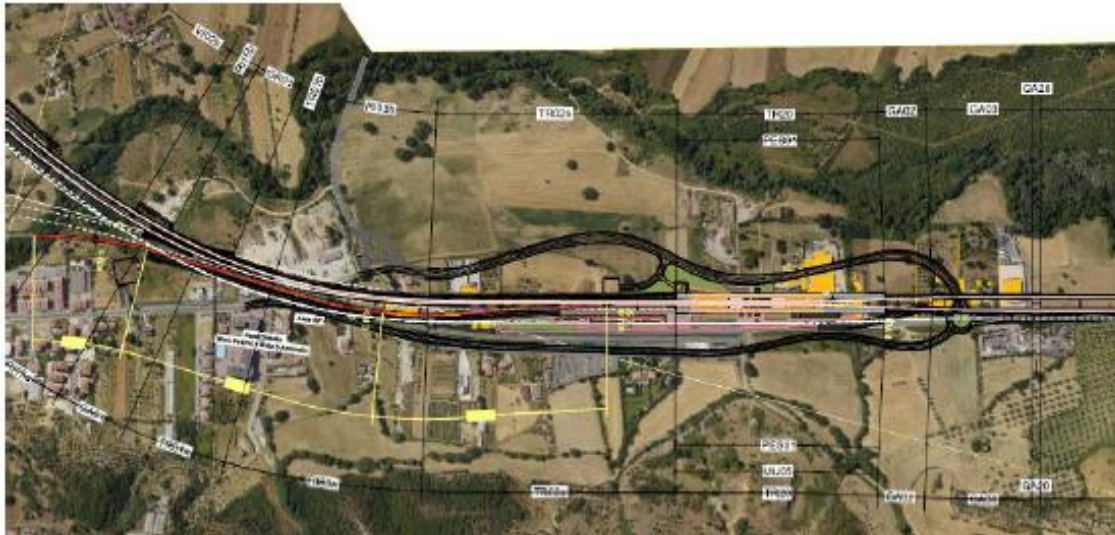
Stralcio planimetria su ortofoto dalla GA01 all'imbocco della GN01 compresa la variante 2 Linea Sibari
